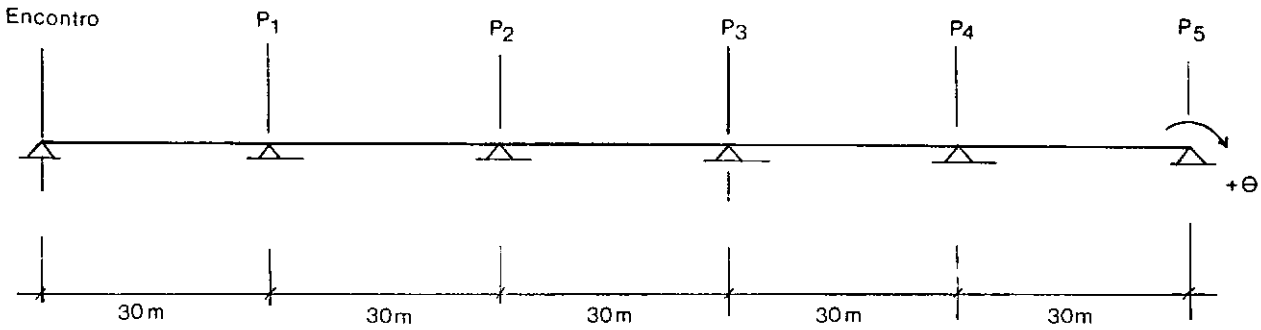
ESQUEMA ESTRUTURAL PARA CÁLCULO DAS VIGAS
